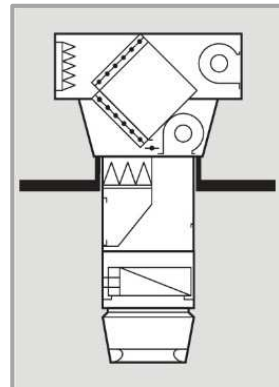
Centrální větrání haly soustředěnými proudy [48]
